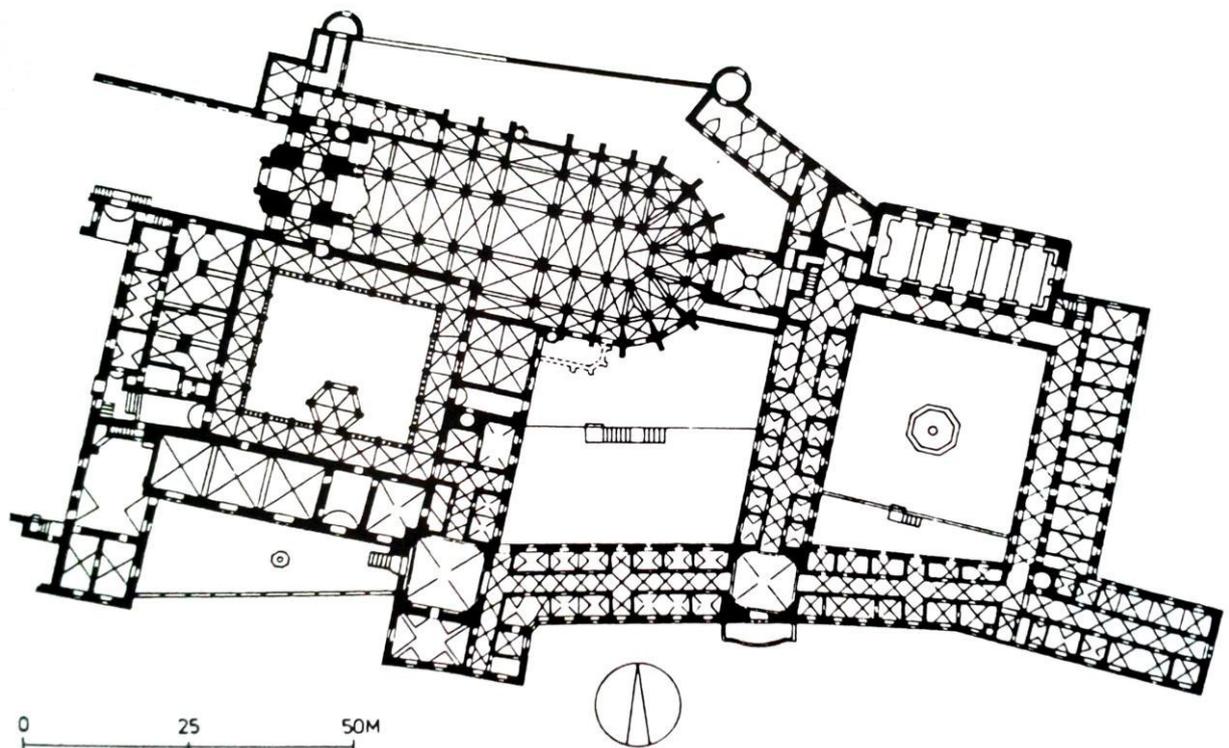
Zisterzienserstift Zwettl, Grundriss.
